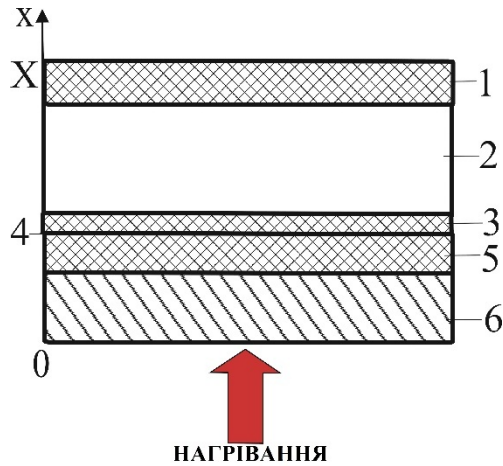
Схема залізобетонного багатопустотного перекриття в одновимірній постановці: 1 – шар суцільного бетону між неогрівною поверхнею і шаром з пустотами перекриття; 2 – шар з пустотами; 3 – шар суцільного бетону між пустотами і арматурою; 4 – шар арматури; 5 – шар суцільного бетону від арматури до поверхні, що обігривається; 6 – штукатурне покриття.
